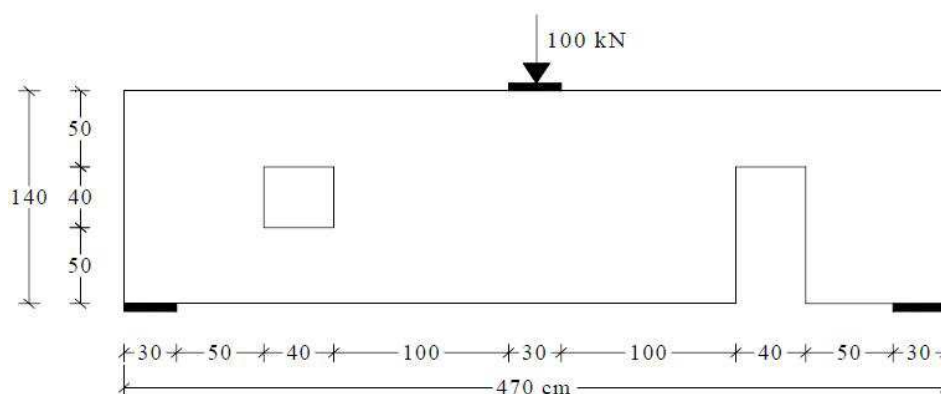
Viga Parede Bi-Apoiada com aberturas
